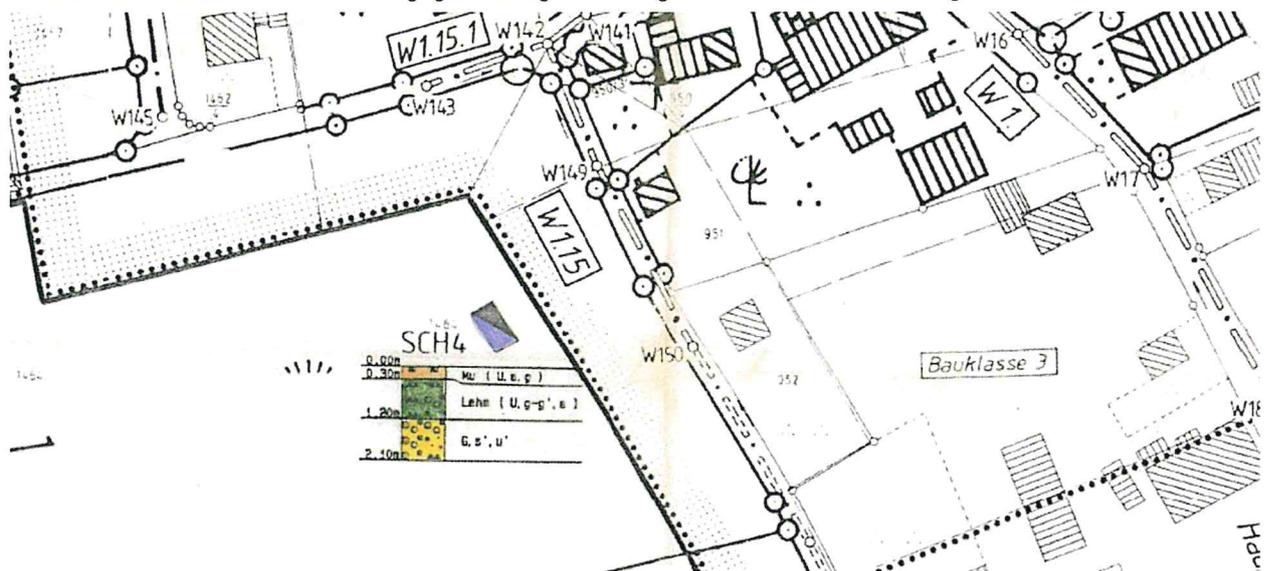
Lageplan Baugrunderkundung mit Schurf Nr. 4 (Crystal Geotechnik 1993)
